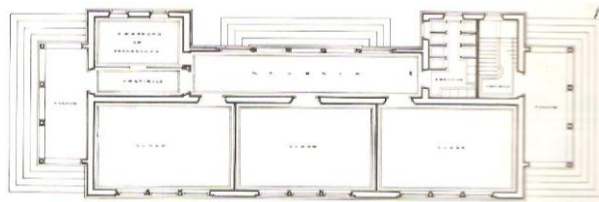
Planta baja. “Aurelio Gómez Millán: Arquitectos”.
